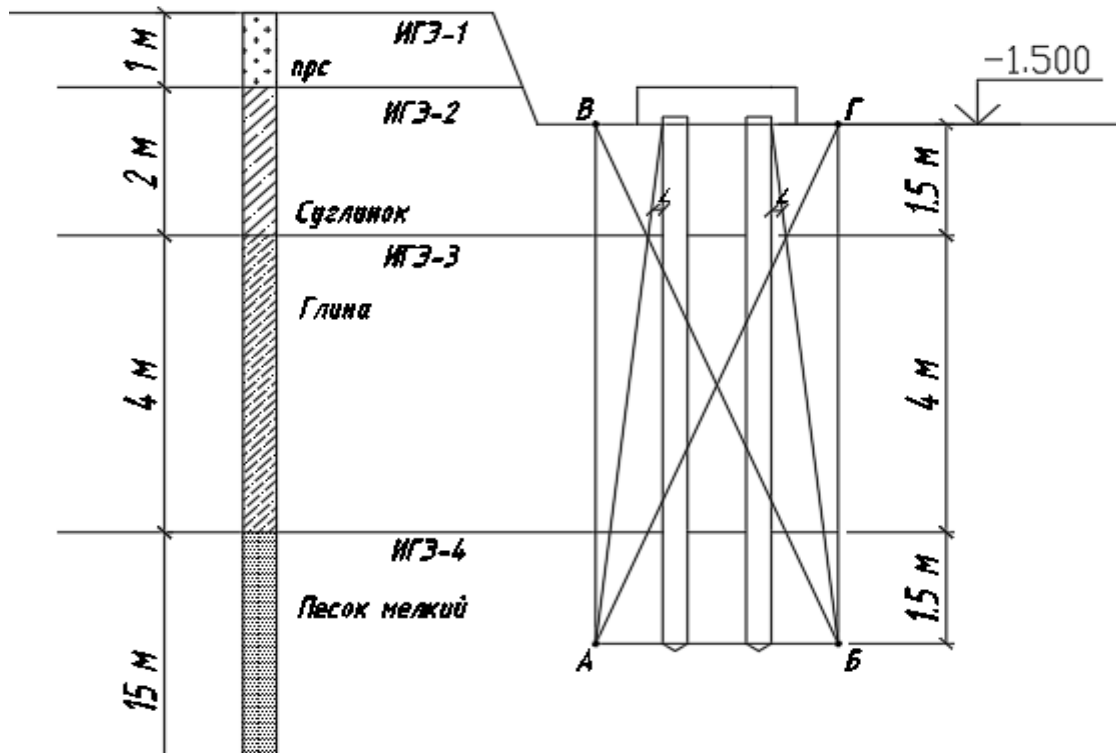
Схема свайного фундамента для расчета по второй группе предельных состояний
